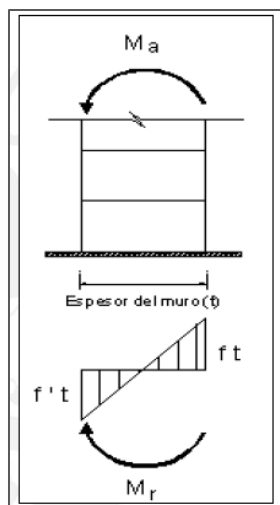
Momento resistente (M_r) de un muro de albañilería (Fuente: Laucata, 2013)
